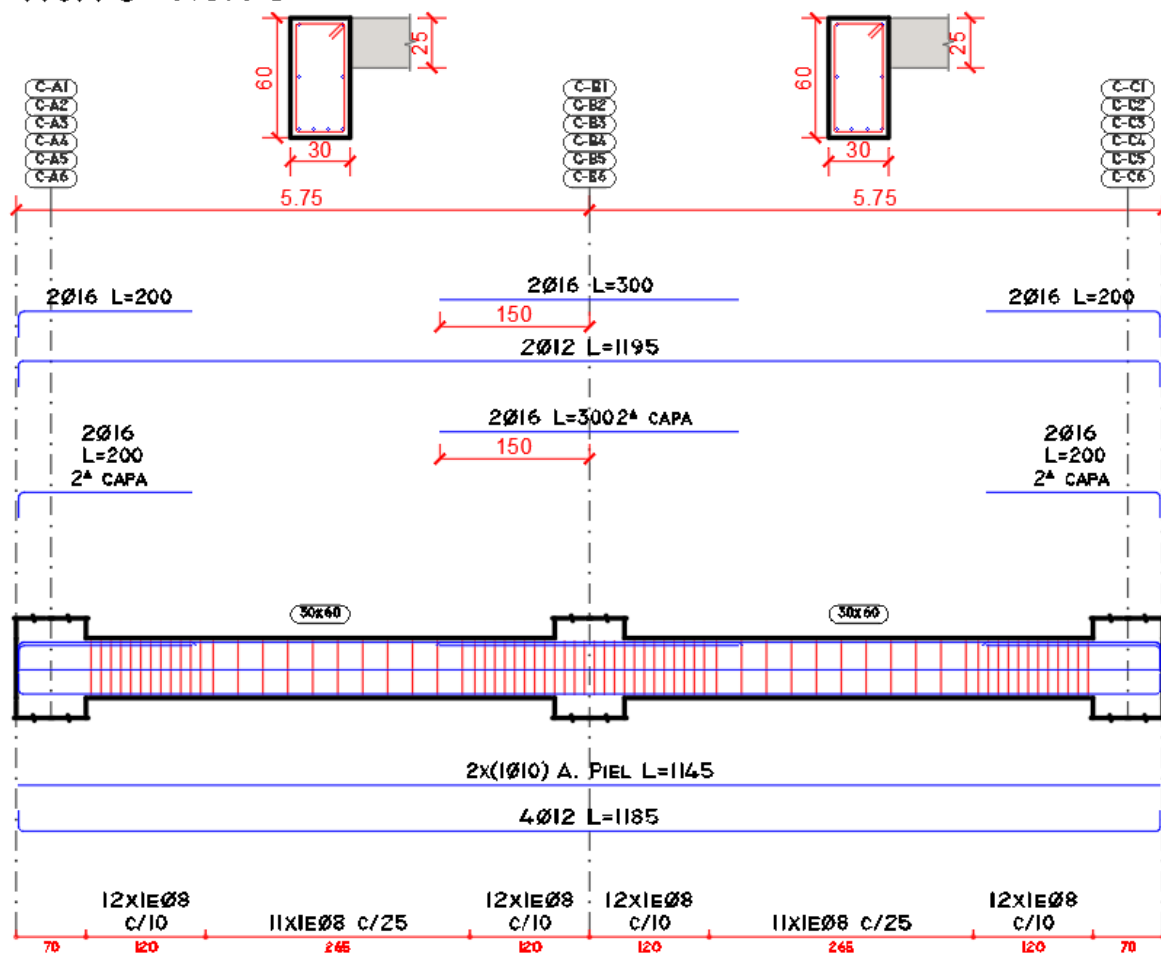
Detalle de Refuerzo Vigas en "X" Losa 1 a 4 Estructura [7N-EE].
